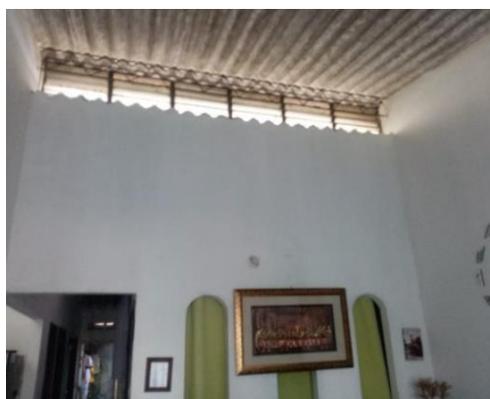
Vivienda 4 grieta. Imagen tomada de: Elaboración propia
